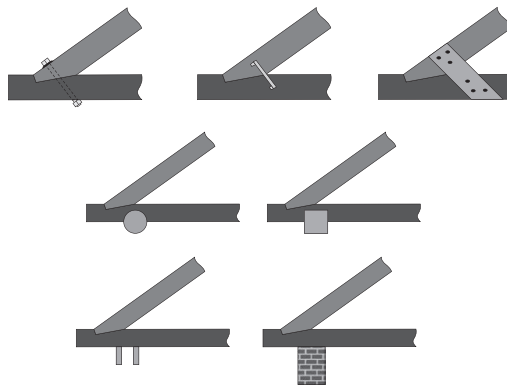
Способы присоединения стропил к балке по типу конструкции стен
